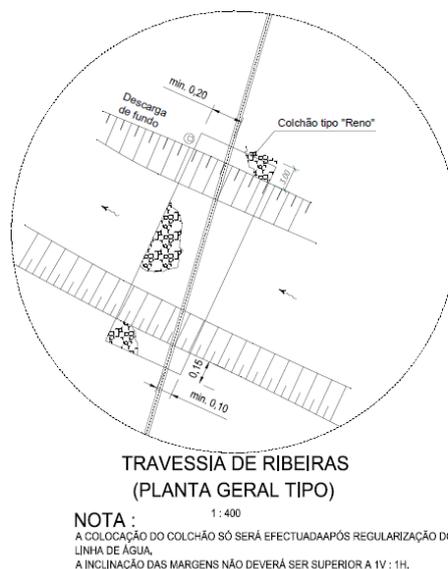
Travessia de ribeiras (planta geral tipo)
